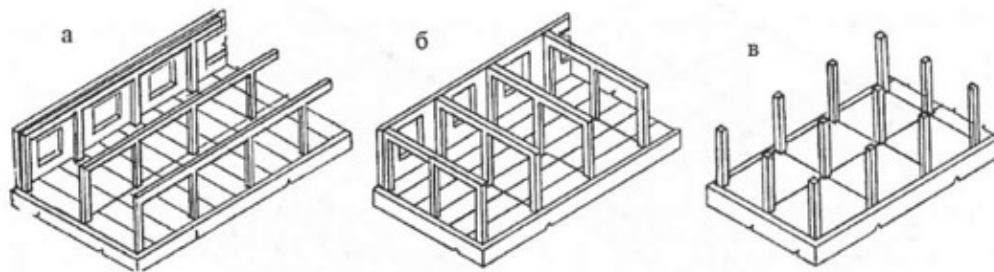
Схема існуючих каркасних систем: 1 – з поздовжнім розташуванням ригелів, 2 – з поперечним розташуванням ригелів, 3 – безригельна каркасна система.
